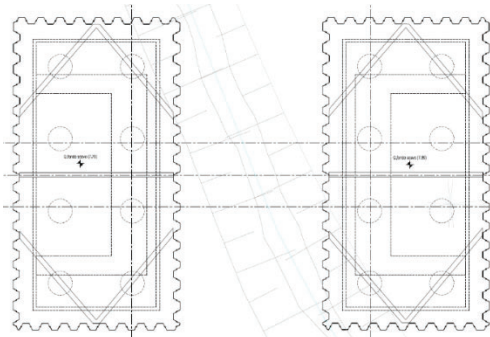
Pianta delle fondazioni delle pile e delle spalle
